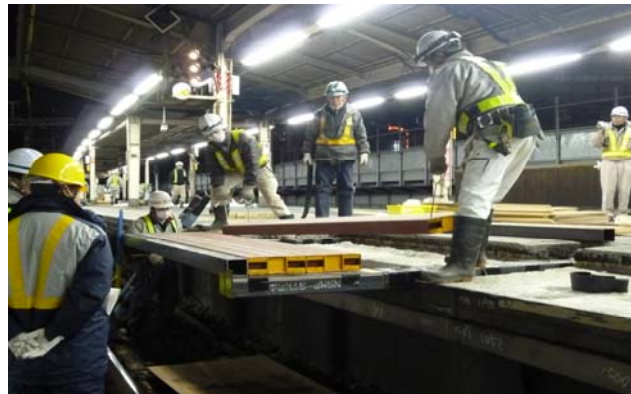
ホーム拡幅試験施工状況写真(Aタイプ)
